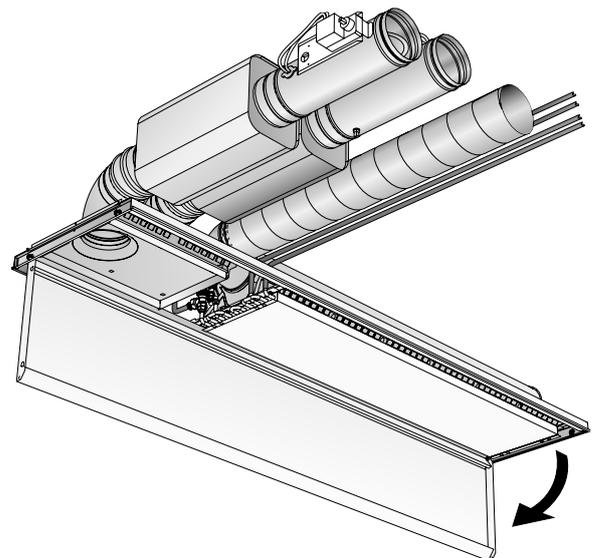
Exemple d'accessibilité d'une PACIFIC SA/EA avec kit VAV via la façade du module de parement.
